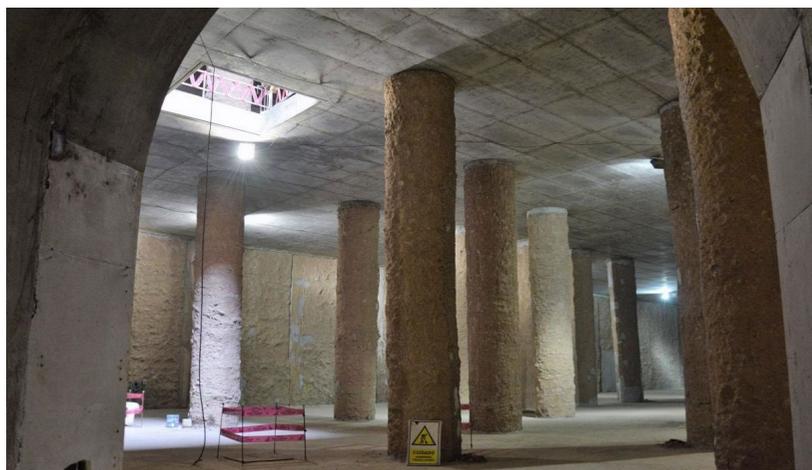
Muros Pantalla y Pilas Pilote ejecutadas en la Estación 24 “Mercado Santa Anita”
